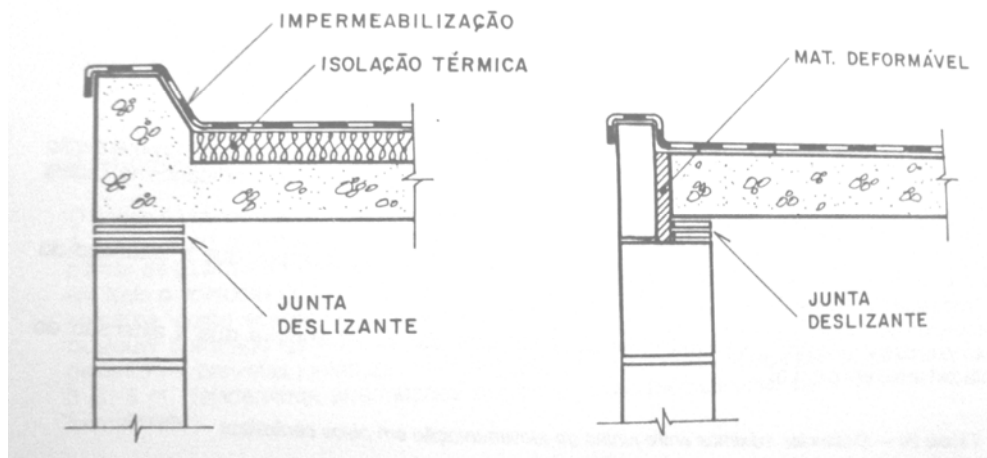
Junta deslizante entre laje de cobertura e alvenaria estrutural
